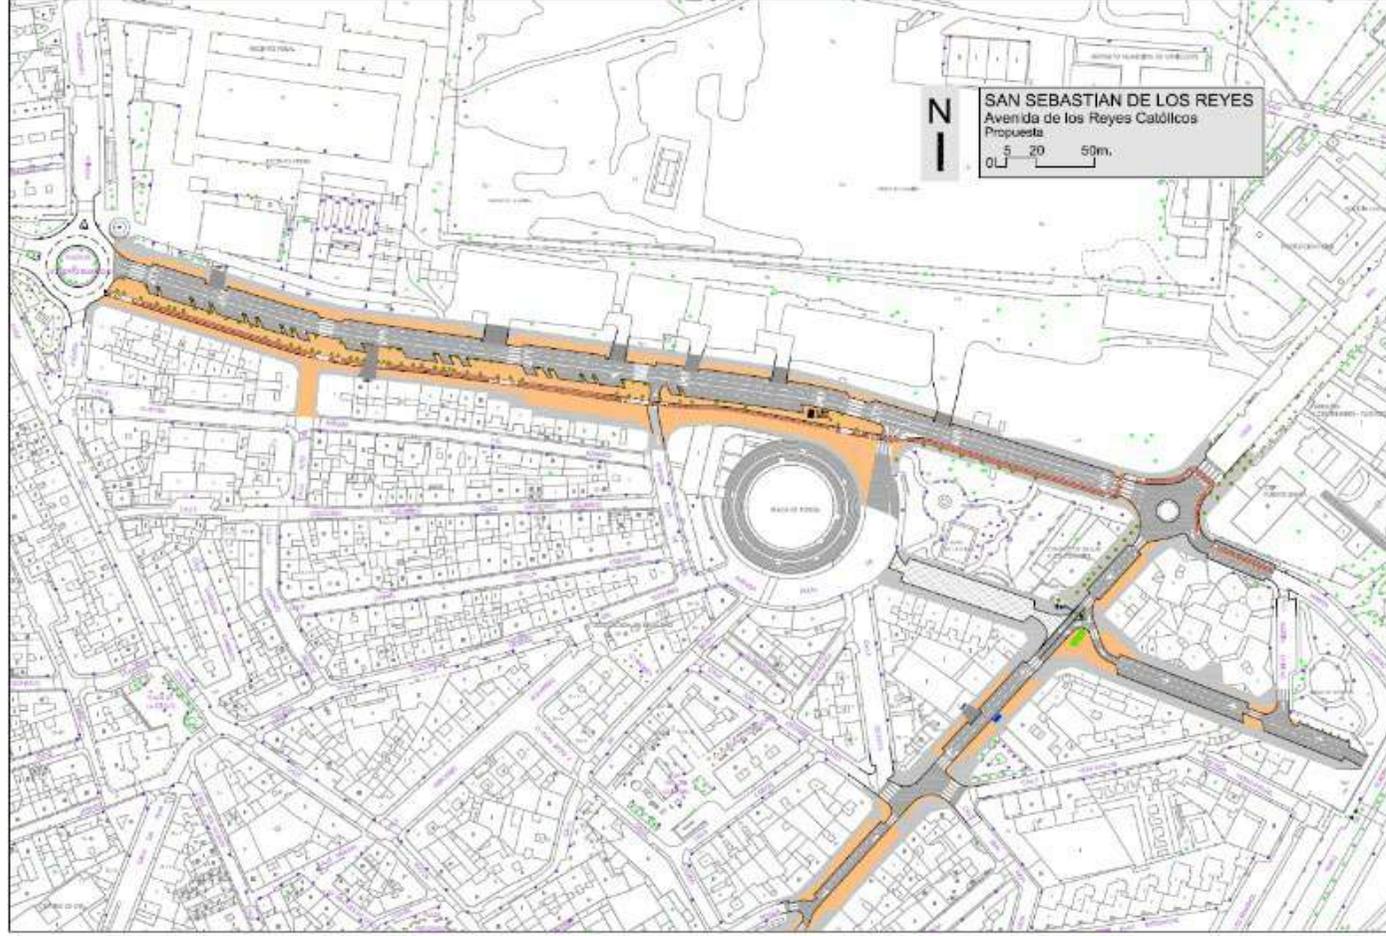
Planta propuesta Alternativa 1 para Avenida Reyes Católicos. Fuente: DOYMO.
